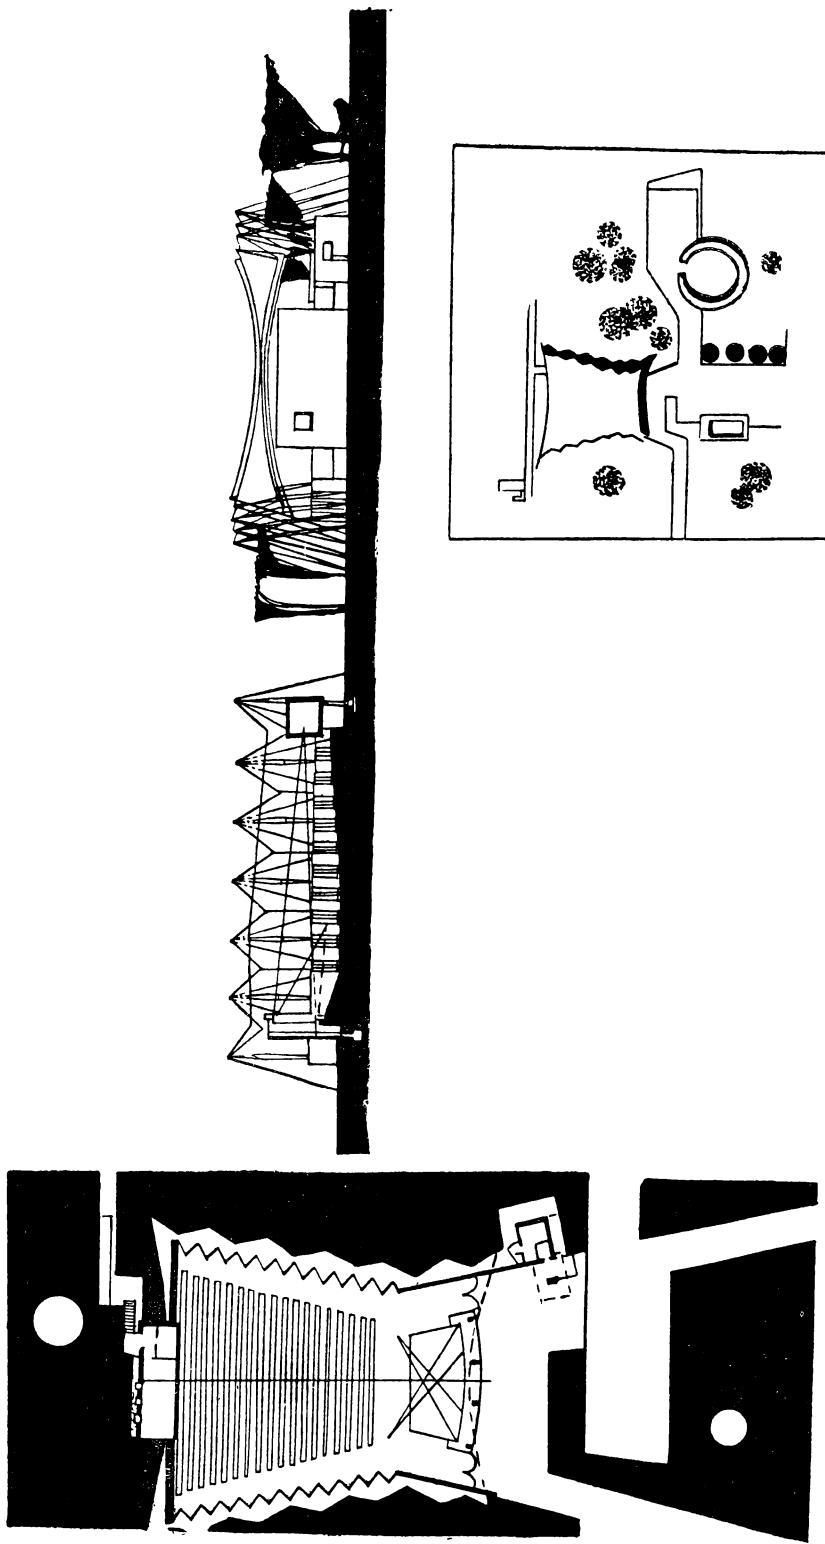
План и разрезы летней киноплощадки на 600 мест
